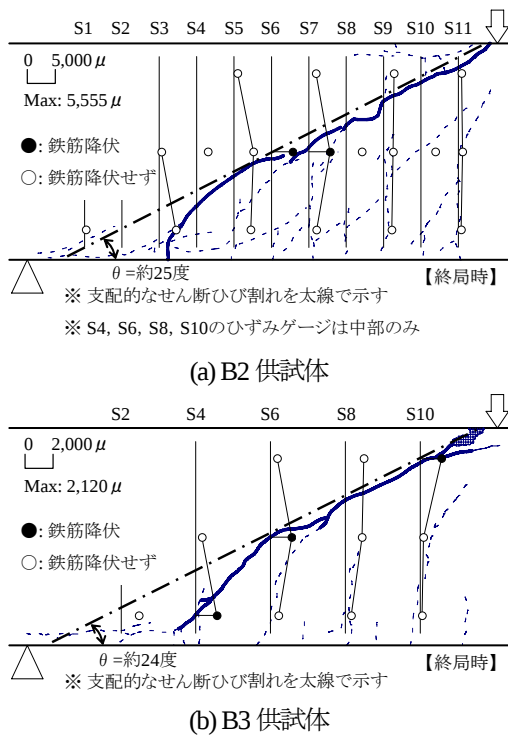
ひび割れとせん断補強鉄筋ひずみ
